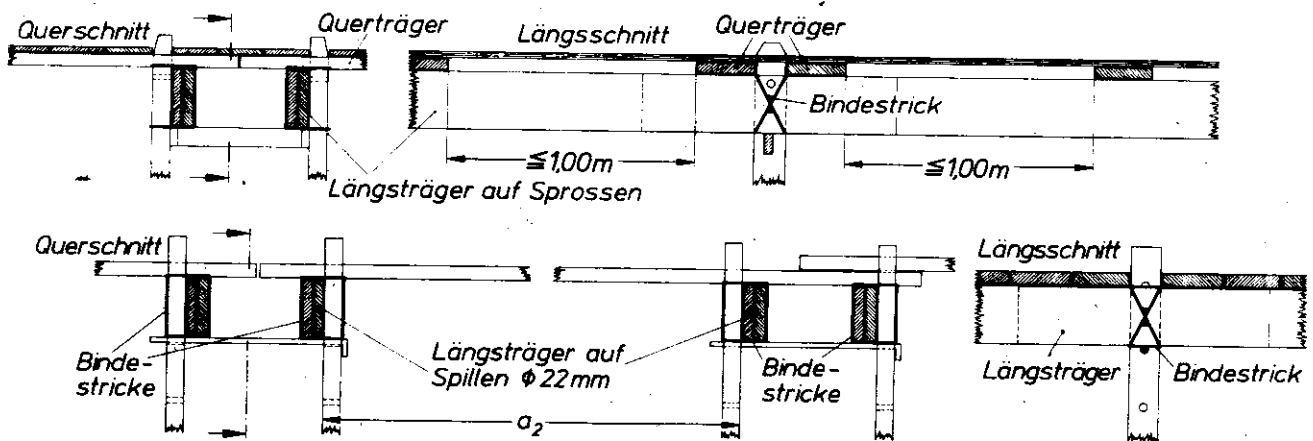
Belagausbildungen für Raumgerüste (siehe Abschnitt 4.3.2 und Bild 13)
